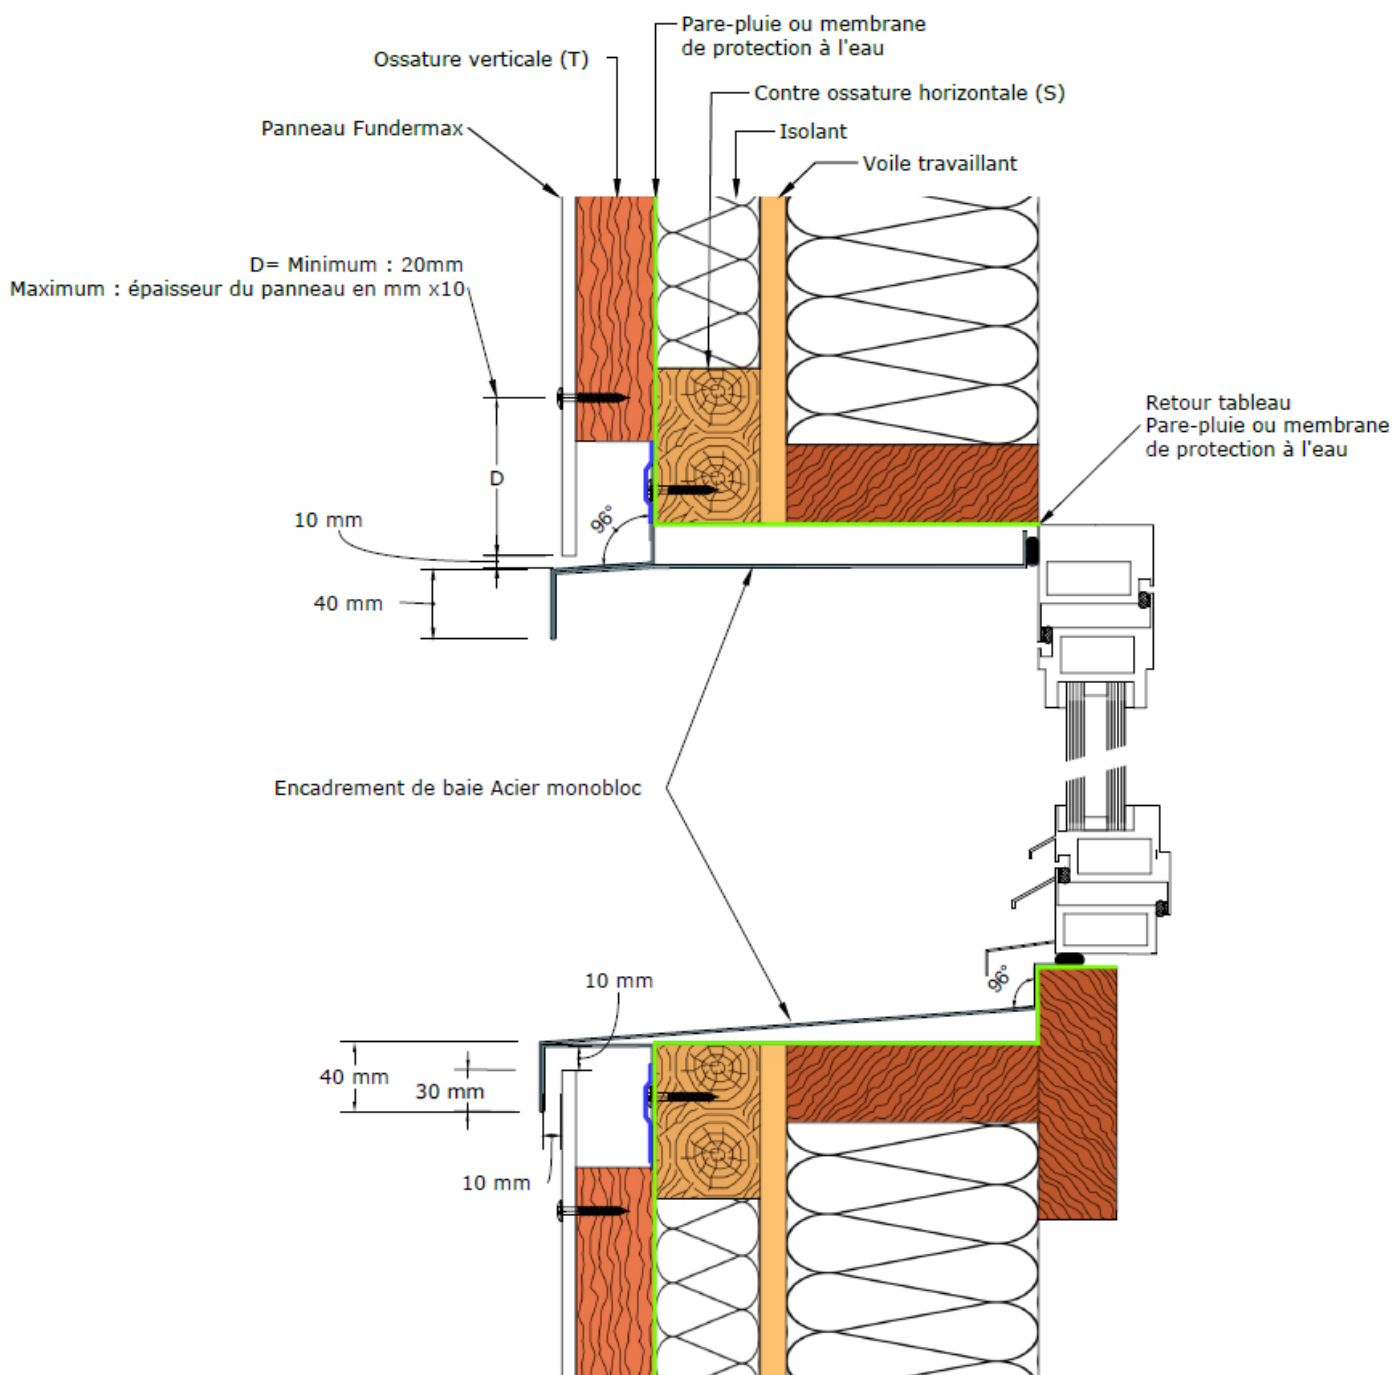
Encadrement de baie Ee2, acier 15/10<sup>e</sup> monobloc soudé 4 cotés, bardage sur FOB avec contre-ossature (S), coupe verticale
